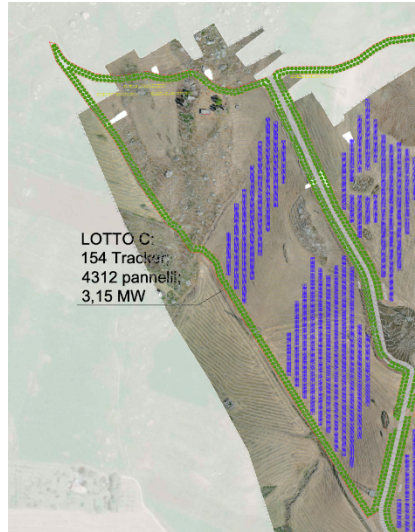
Particolare Layout di impianto area C su stralcio rilievo
